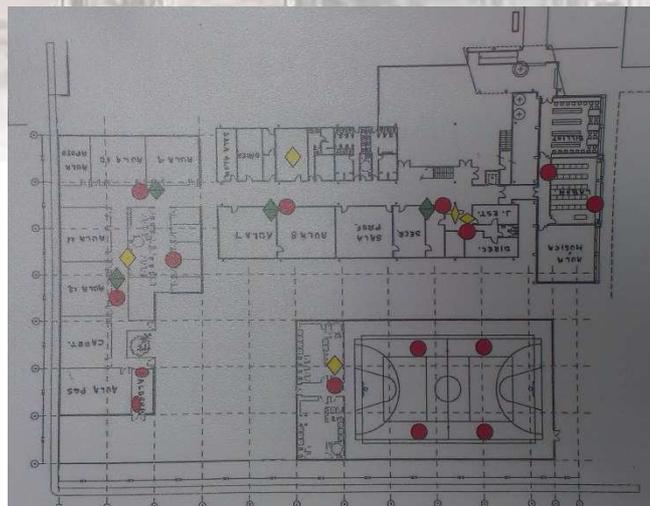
Ubicación extintores y BIES según Plan de Autoprotección del centro Fuente: Fotografía de la autora
